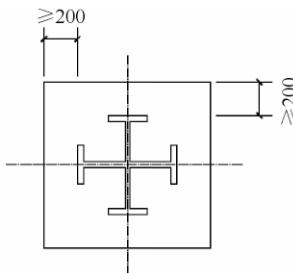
型钢混凝土柱中型钢保护层最小厚度
